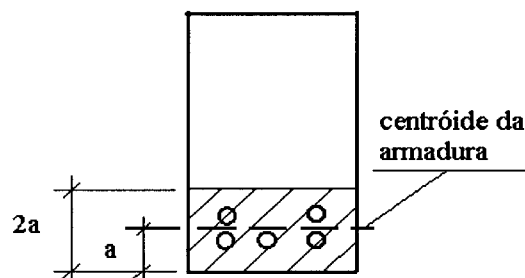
Área do concreto tracionado (ACI 318/89)
